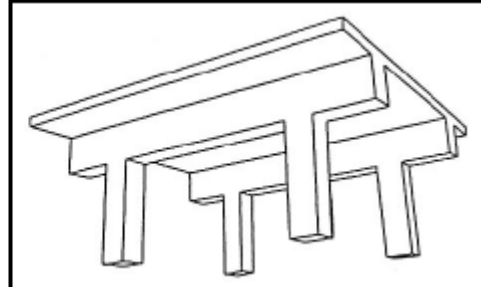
k. Diseño de losa de vigas de canto en una dirección. [A3]
